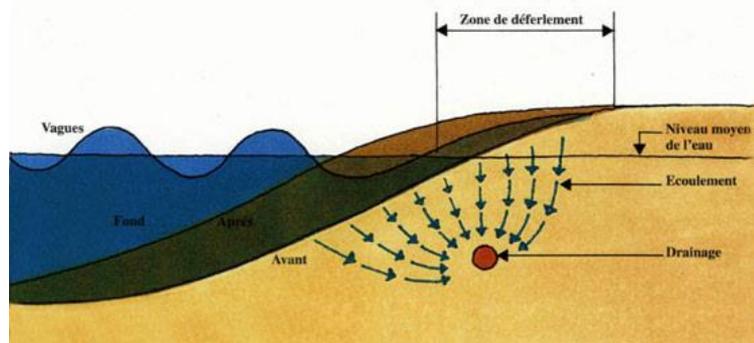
Schéma de principe d'un drainage de plage. ECOPLAGE ®
